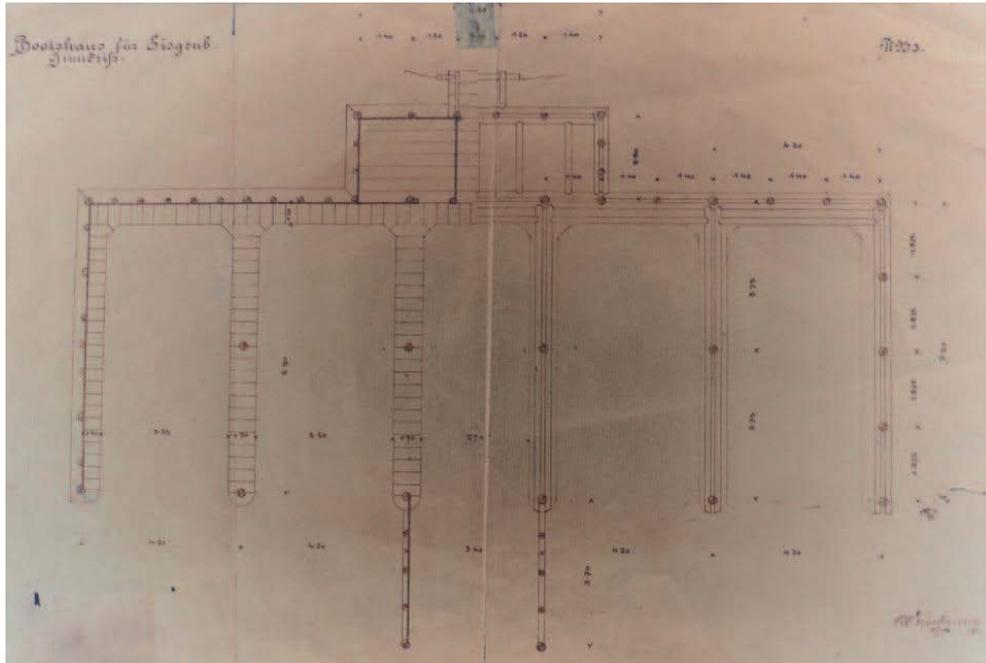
, Plan „Bootshaus für Eisgrub. Grundriß.“ /
